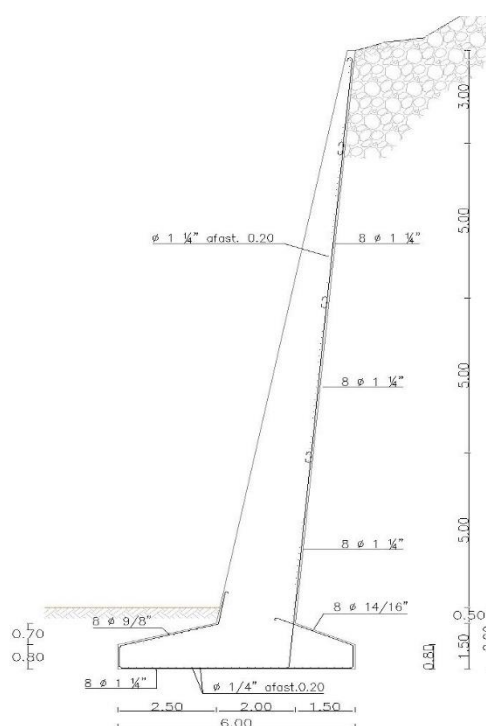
Corte de um dos muros de contenção demonstrando a geometria inicial (Ferreira, 1955)
